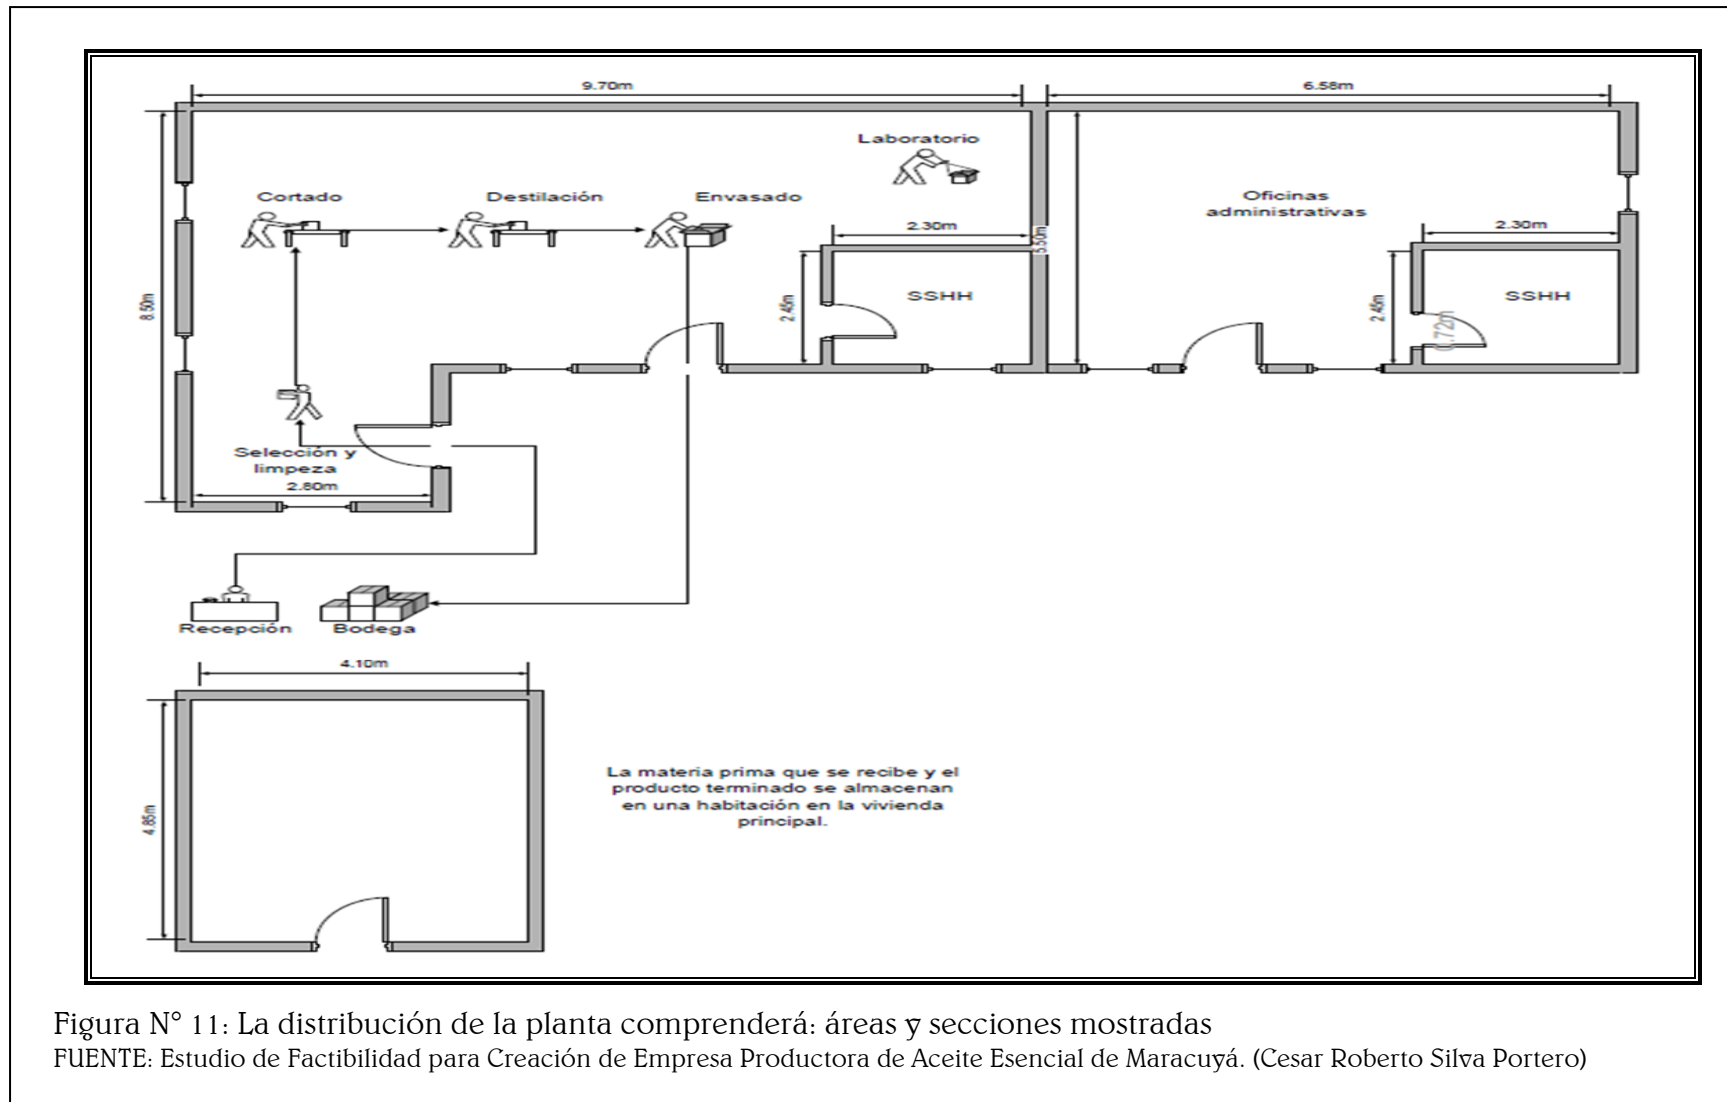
La distribución de la planta comprenderá: áreas y secciones mostradas
